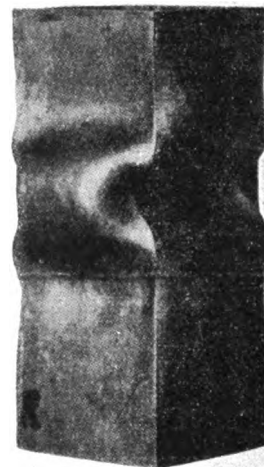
Deformazione d'un tubo a sezione quadrata.
